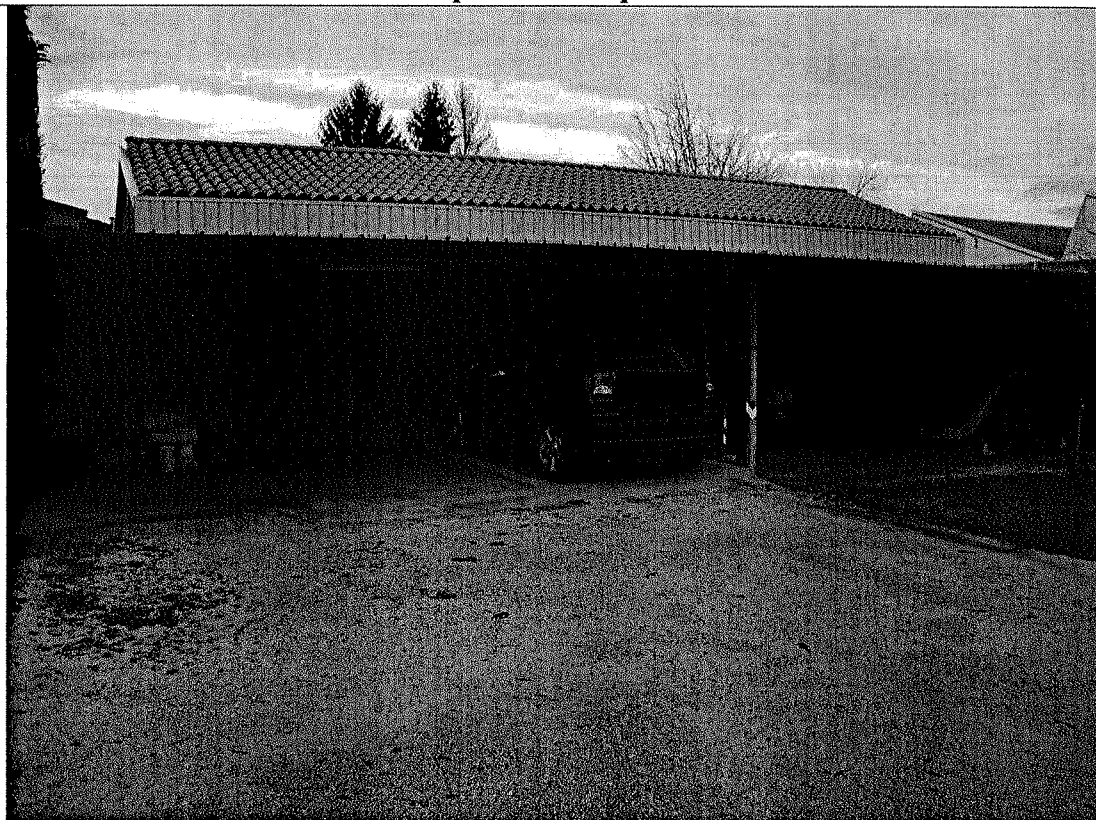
vista dell'area scoperta a sud-est del lotto
